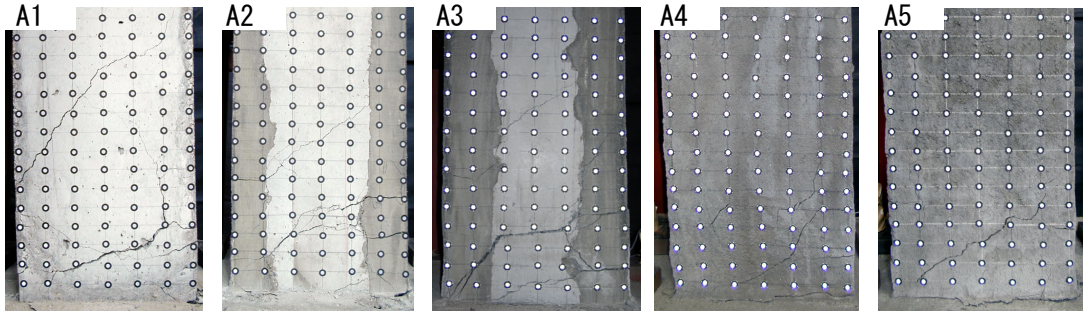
ひび割れ状況 (6 δ_y 1回目正載荷時：写真左向きに載荷)
